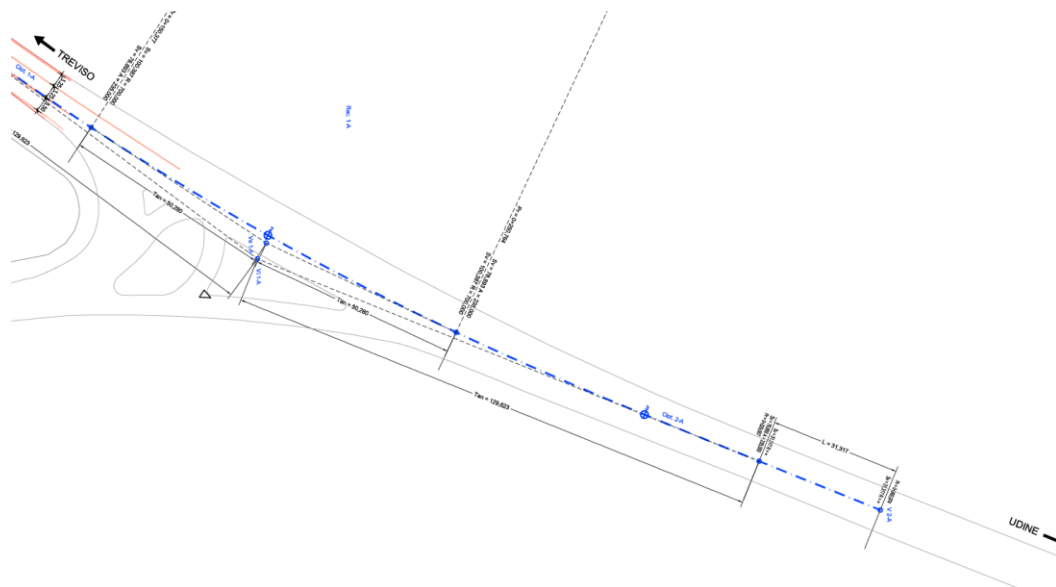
Andamento planimetrico riqualificazione tracciato S.S. n. 13
